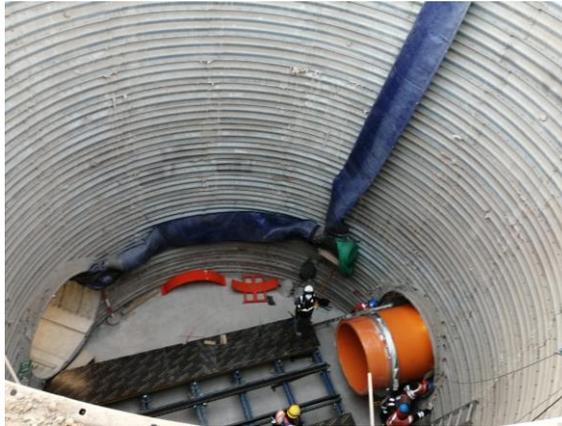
Colocación de tubería HDPE 1600 mm
